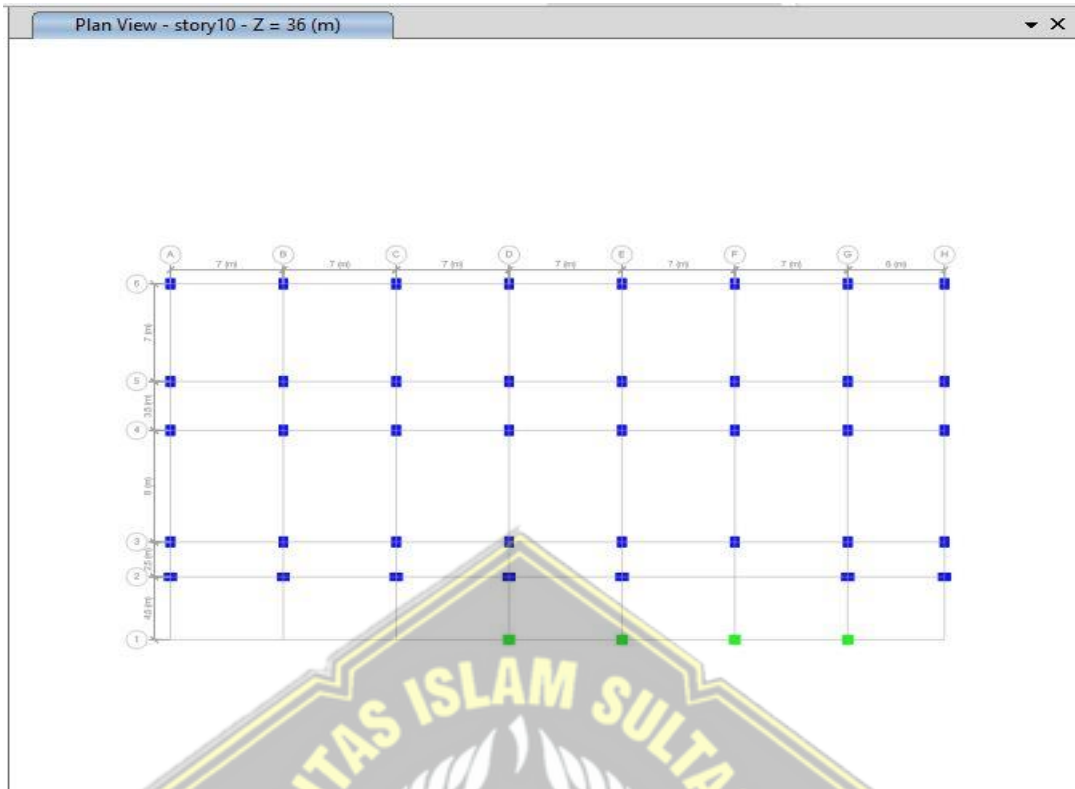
Denah Kolom Lantai 4 dan 5
